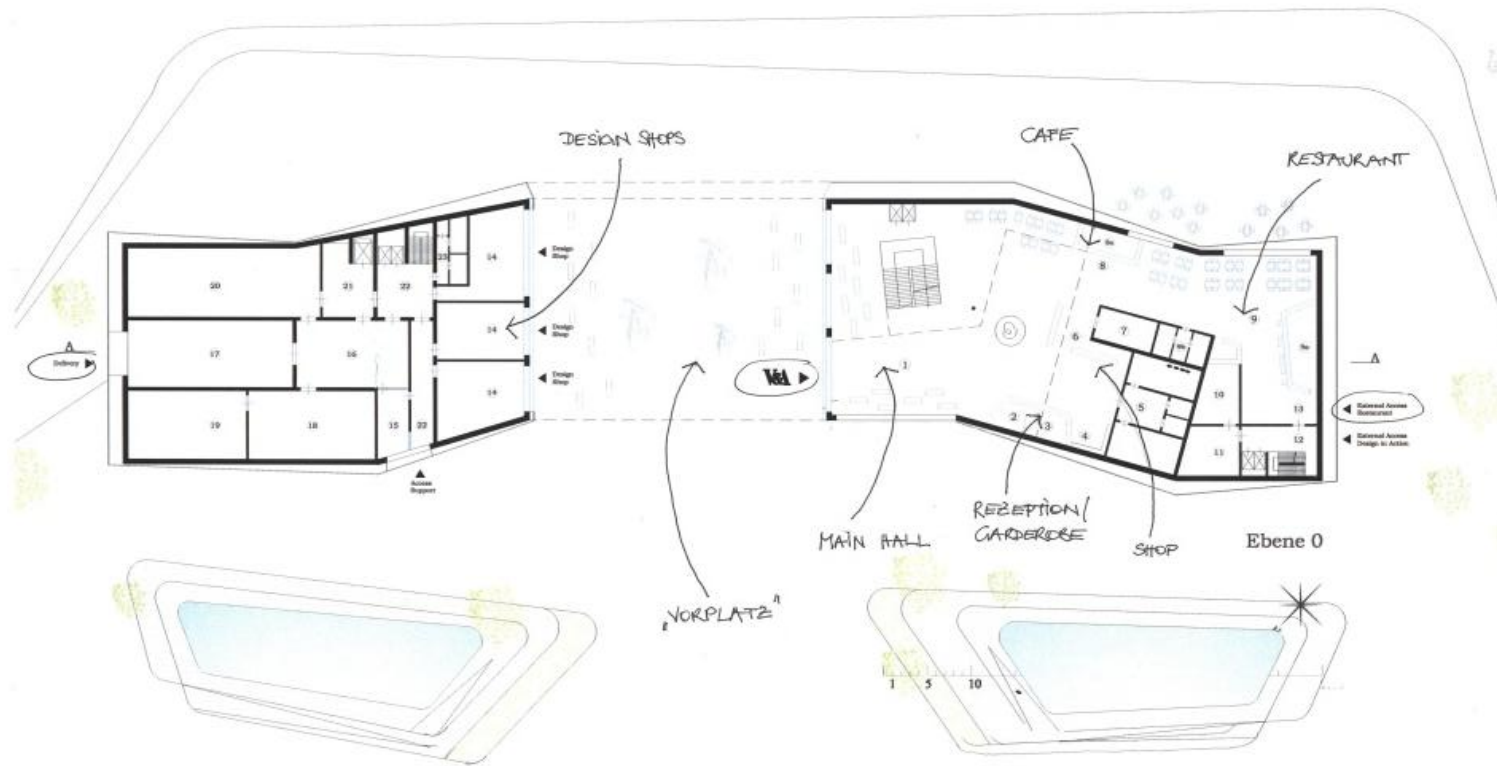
Übersicht Grundriss Ebene 0
